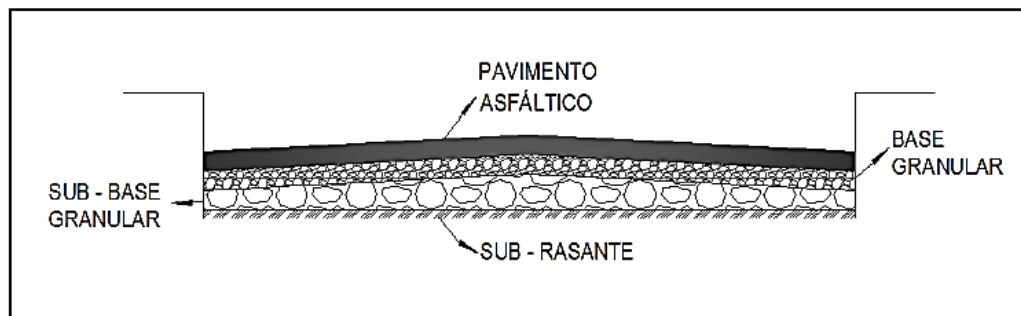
Sección de un pavimento flexible (Salazar, 2008).
